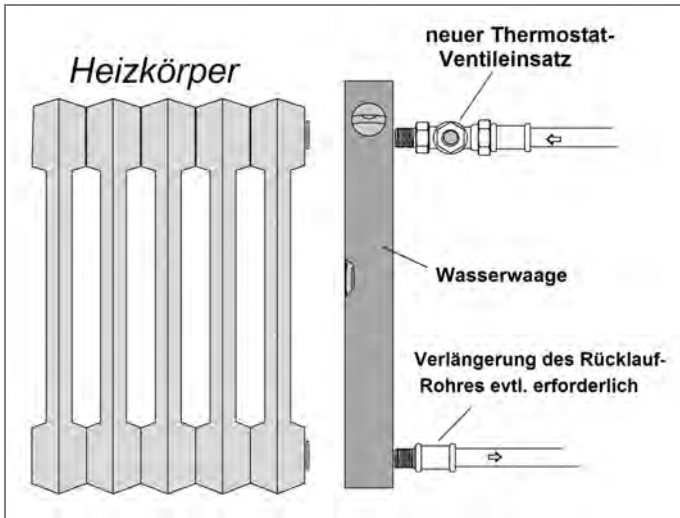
Die Anschlussverschraubung sollte keine Längenunterschiede aufweisen, die sich nicht leicht auffangen lassen.
